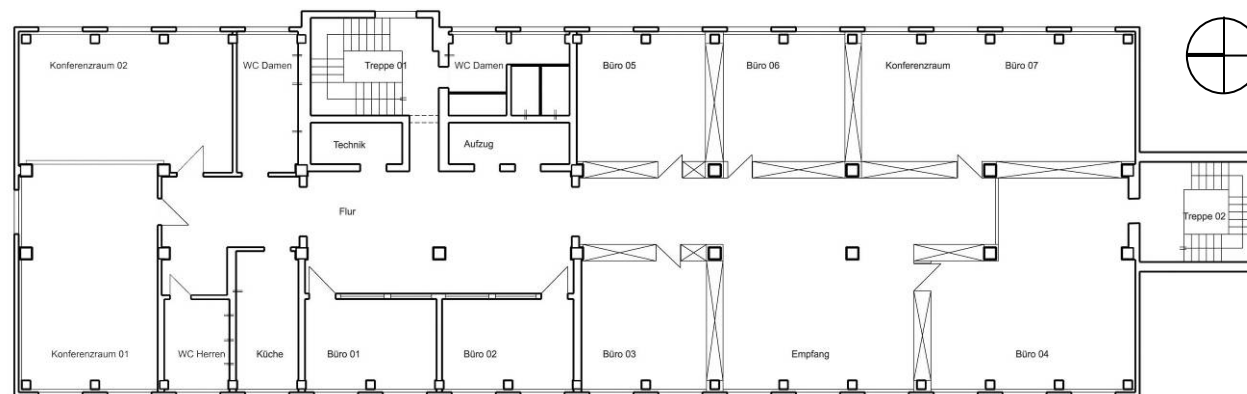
Grundriss - Regelgeschoss (2.OG)
